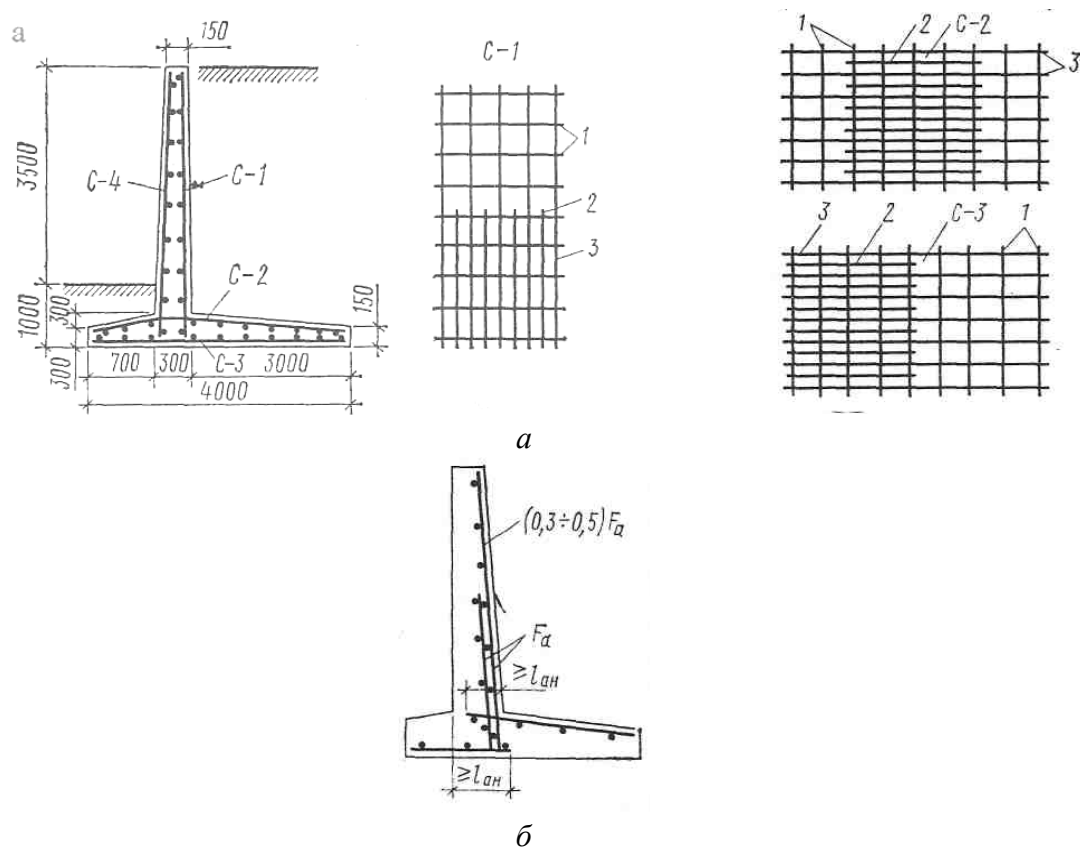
Армирование угловых стен сварными сетками: 1 – распределительные стержни; 2 – дополнительные рабочие стержни; 3 – сквозные рабочие стержни
